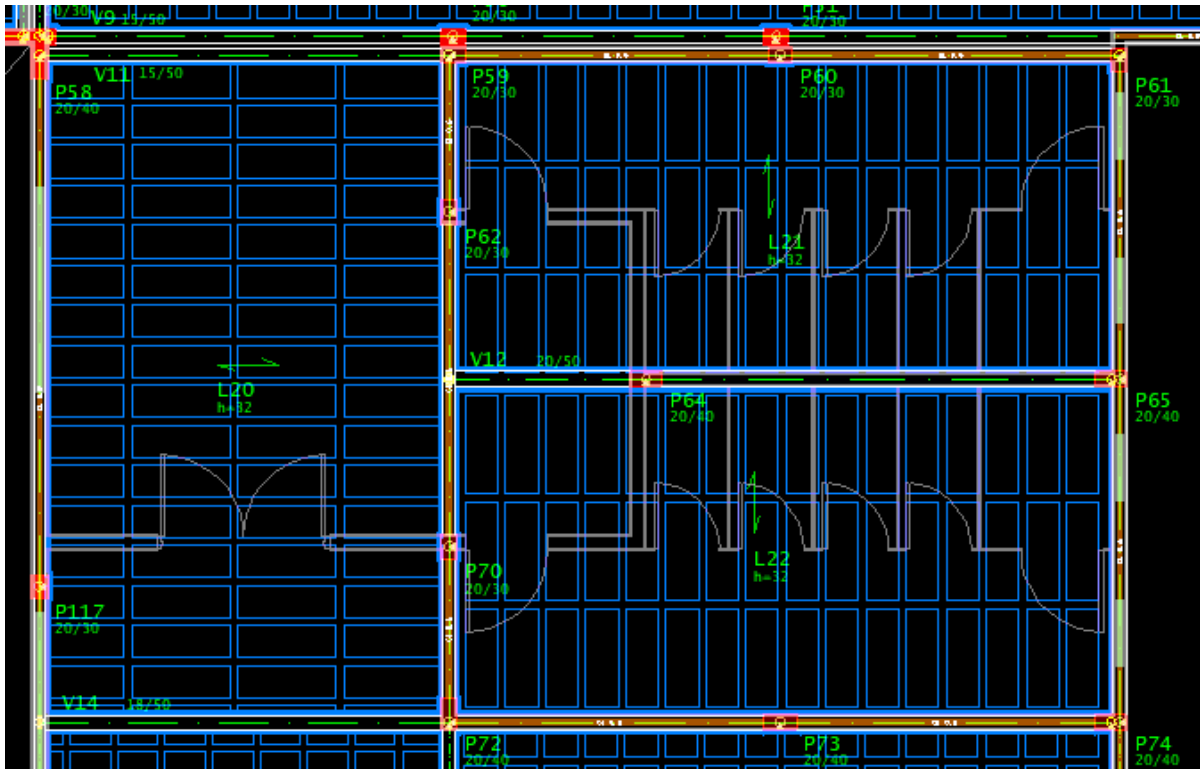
Lajes na região dos banheiros, nível 680 cm, com vigas apoiadas indicadas
